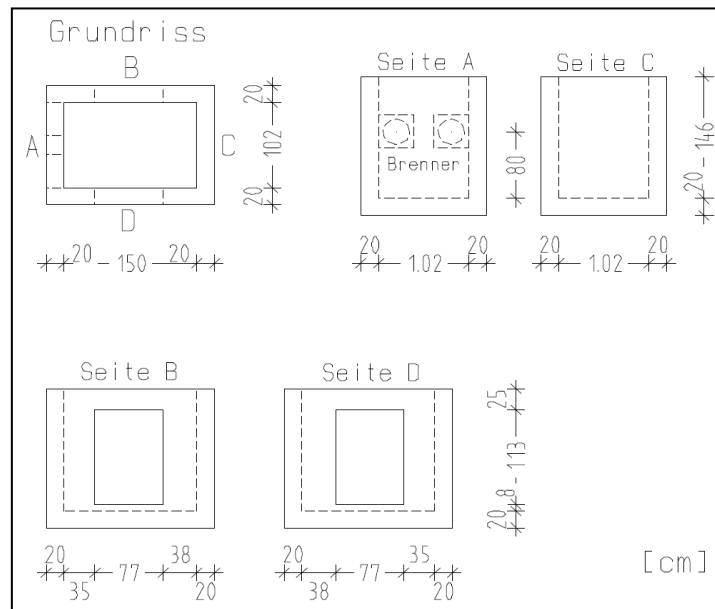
Aufbau des kleinen Deckenbrandhauses [4]
